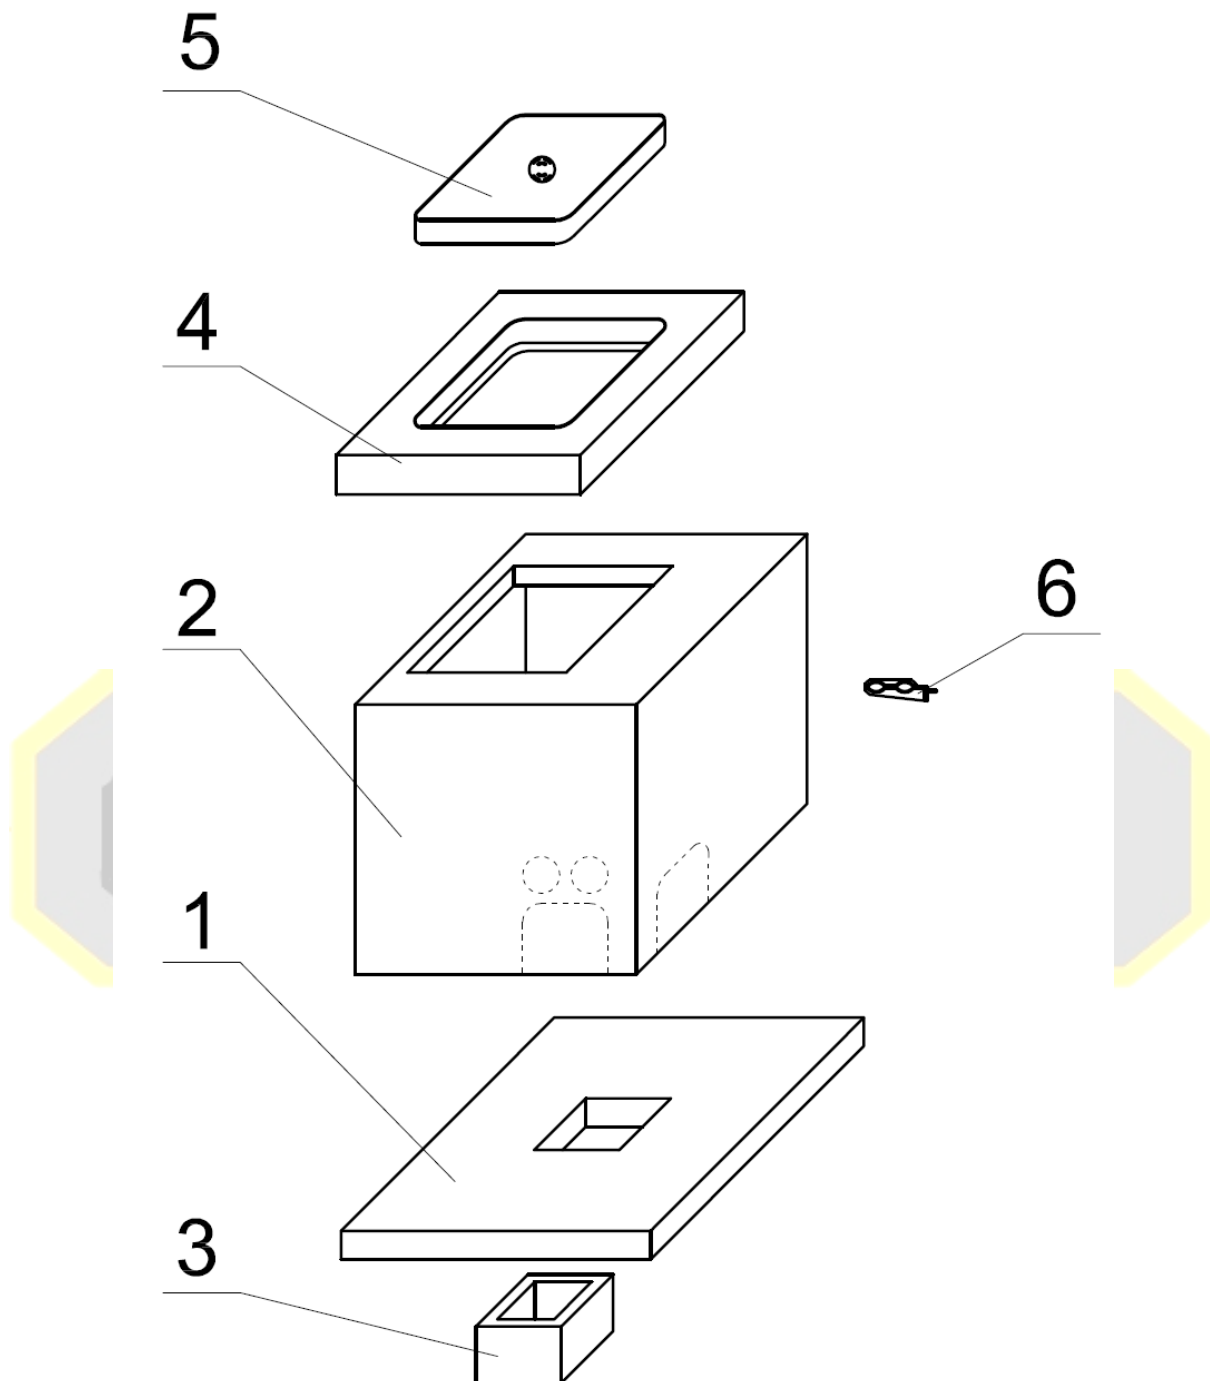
Montaż elementów studni kablowej SKR, SKM
